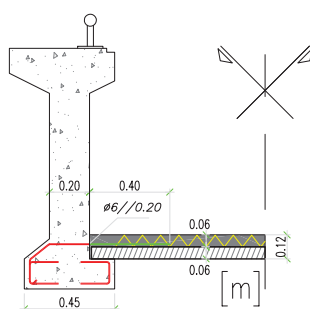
Pormenor de selagem da pré-laje às vigas pré-fabricadas [62]
